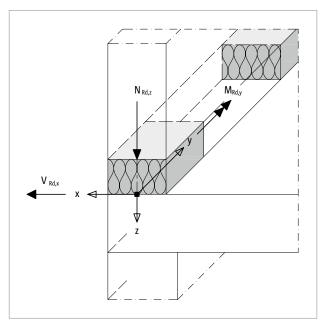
Schöck Isokorb® T tipo AP: regola dei segni per il calcolo di parapetti sovrapposti
